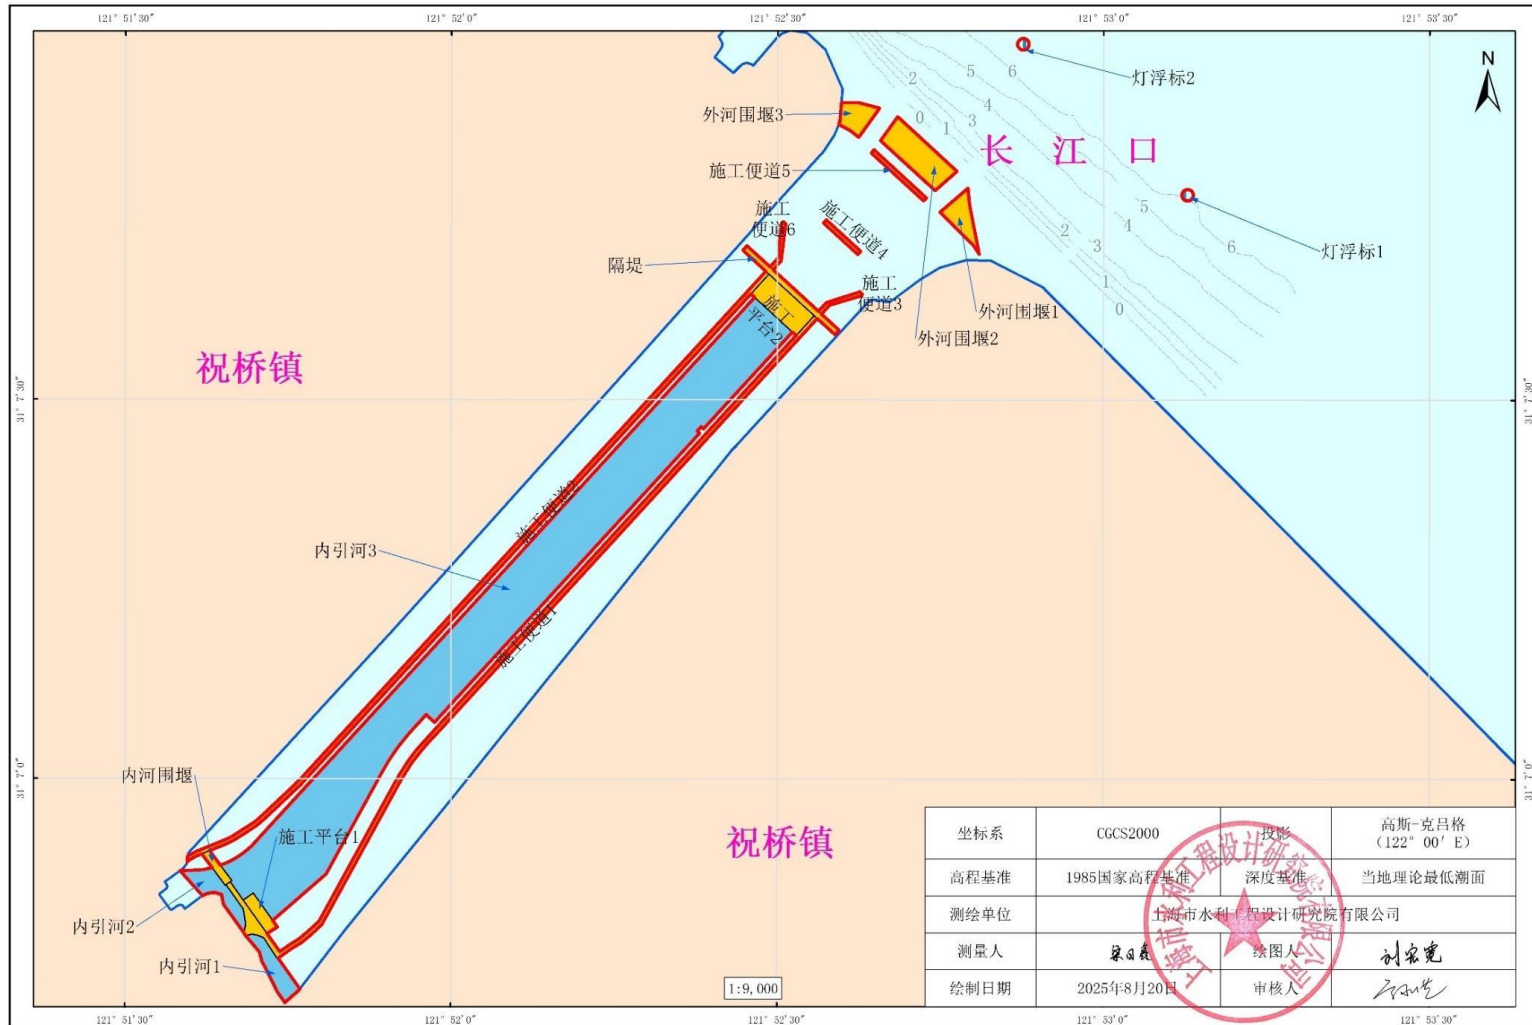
已批复宗海平面布置图（施工配合设施）
